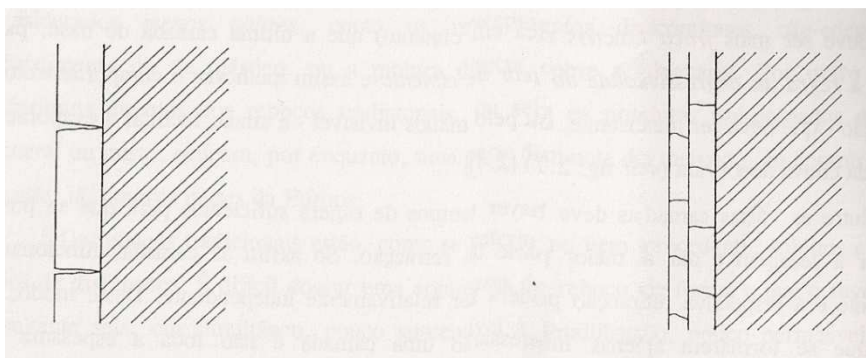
Pormenor da fendilhação de um reboco quando aplicado numa única camada espessa ou em duas camadas de menor espessura, respectivamente [33]
